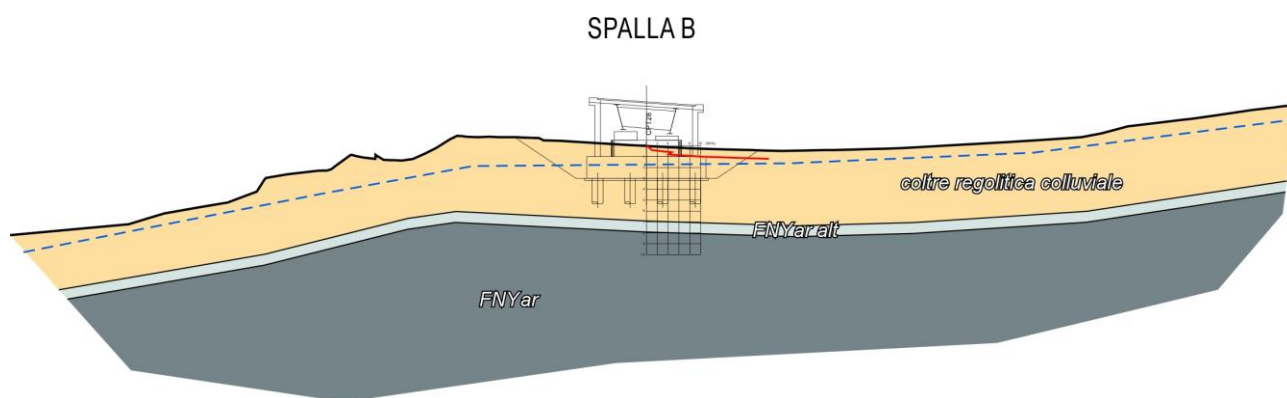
Sezione geologica trasversale – Spalla B.
